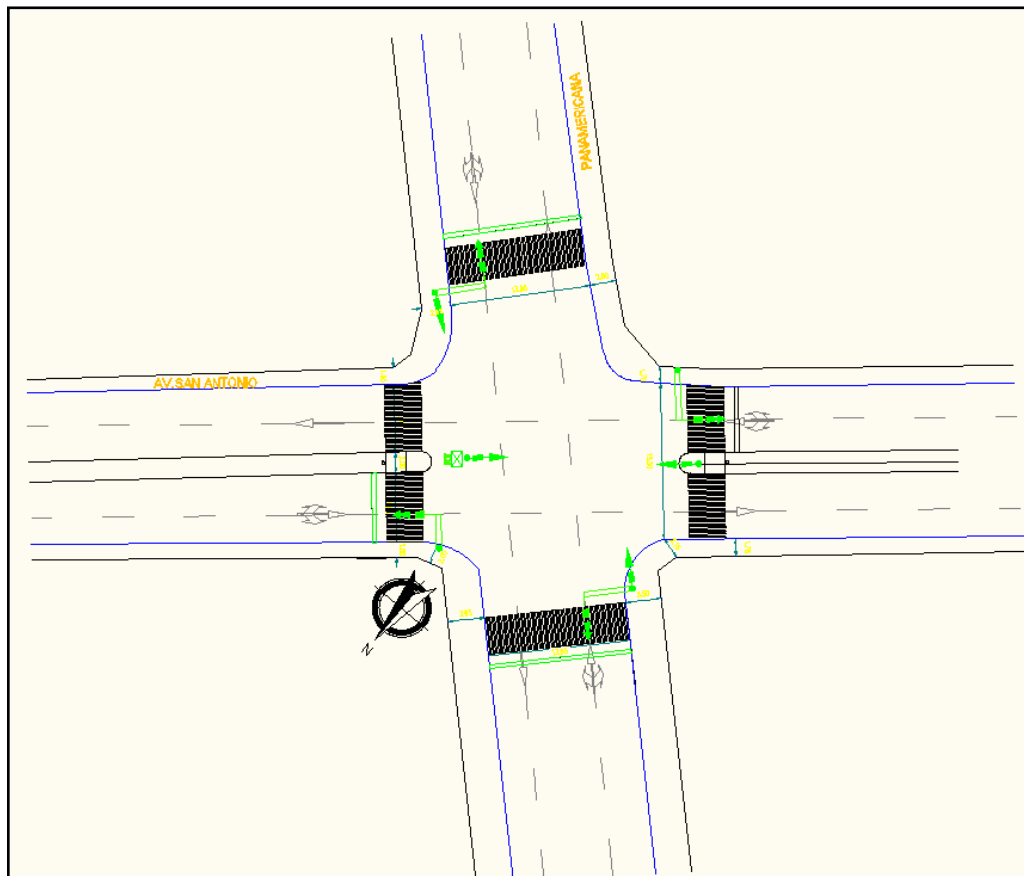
Plano de la Intersección. FUENTE: El Autor.
